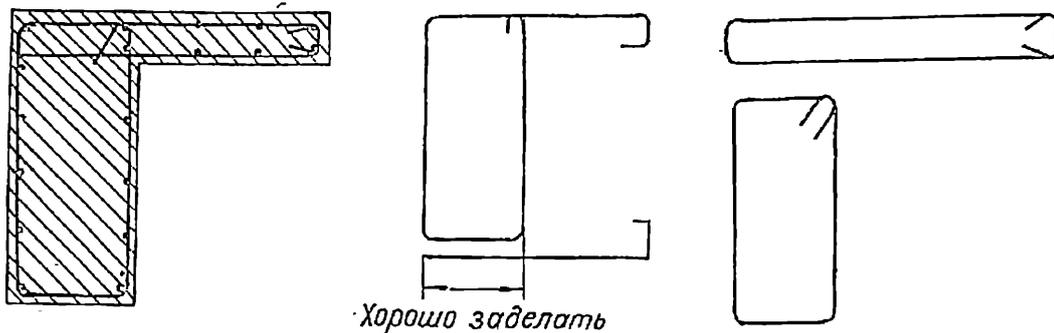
5. Поперечная арматура в элементах составного сечения, устанавливаемая по всему периметру
